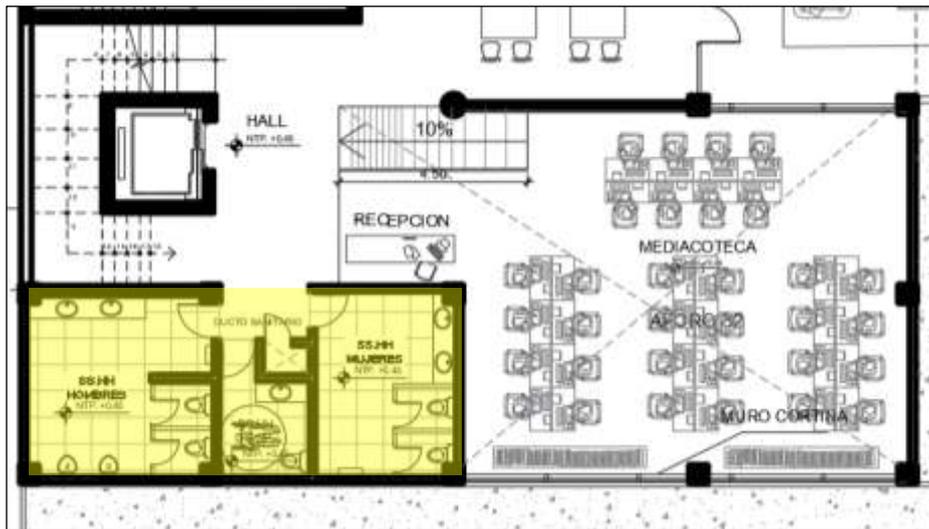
Planta segundo nivel del proyecto-Biblioteca.
